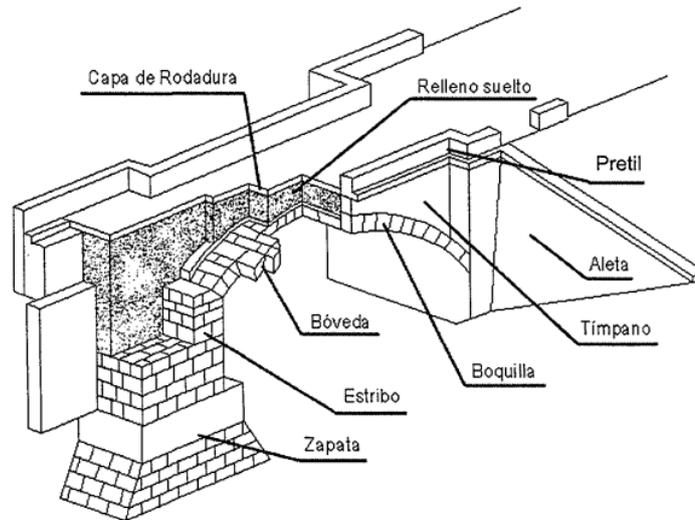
Elementos constitutivos de un puente de fábrica.
